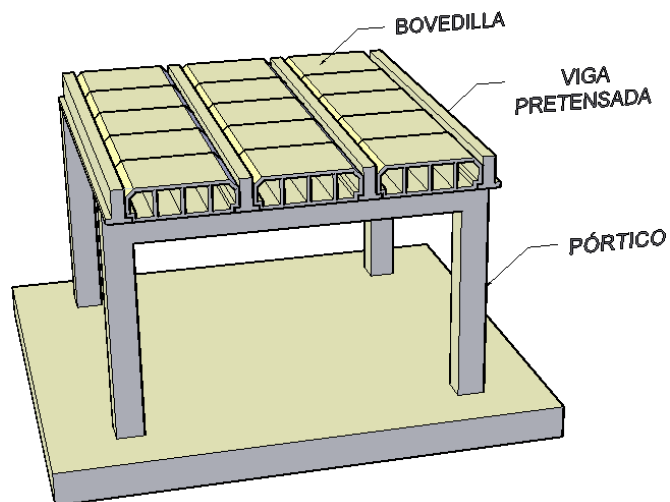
Vigas y bovedillas, previo a la colocación de la carpeta de hormigón armado.
